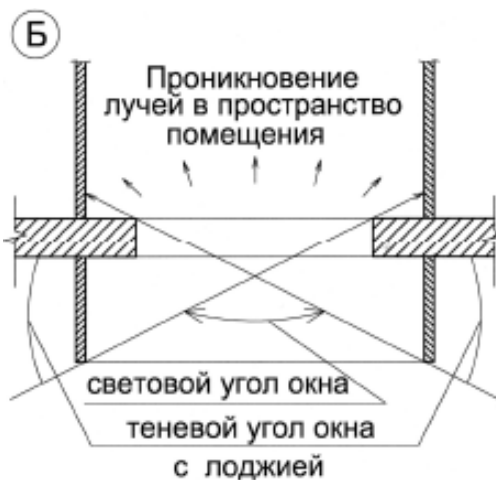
Б - Определение теневого угла окна на плане помещения с лоджией
